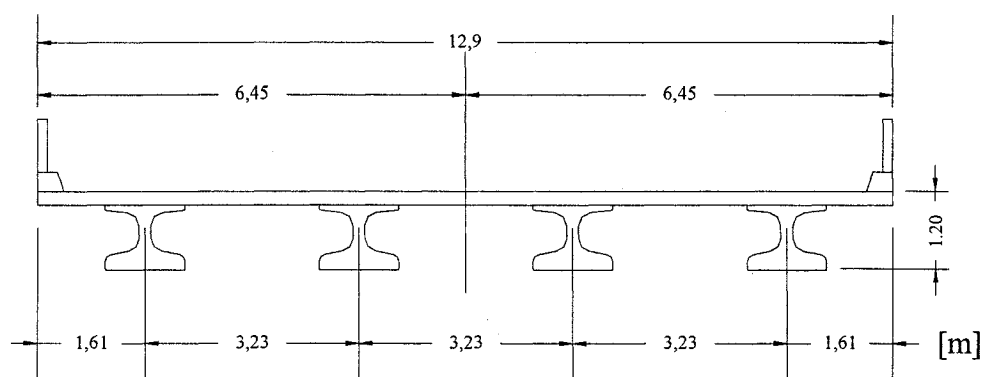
Dimensionnement minimal avec du BFUP-150MPa : 4 poutres NEBT 1000
